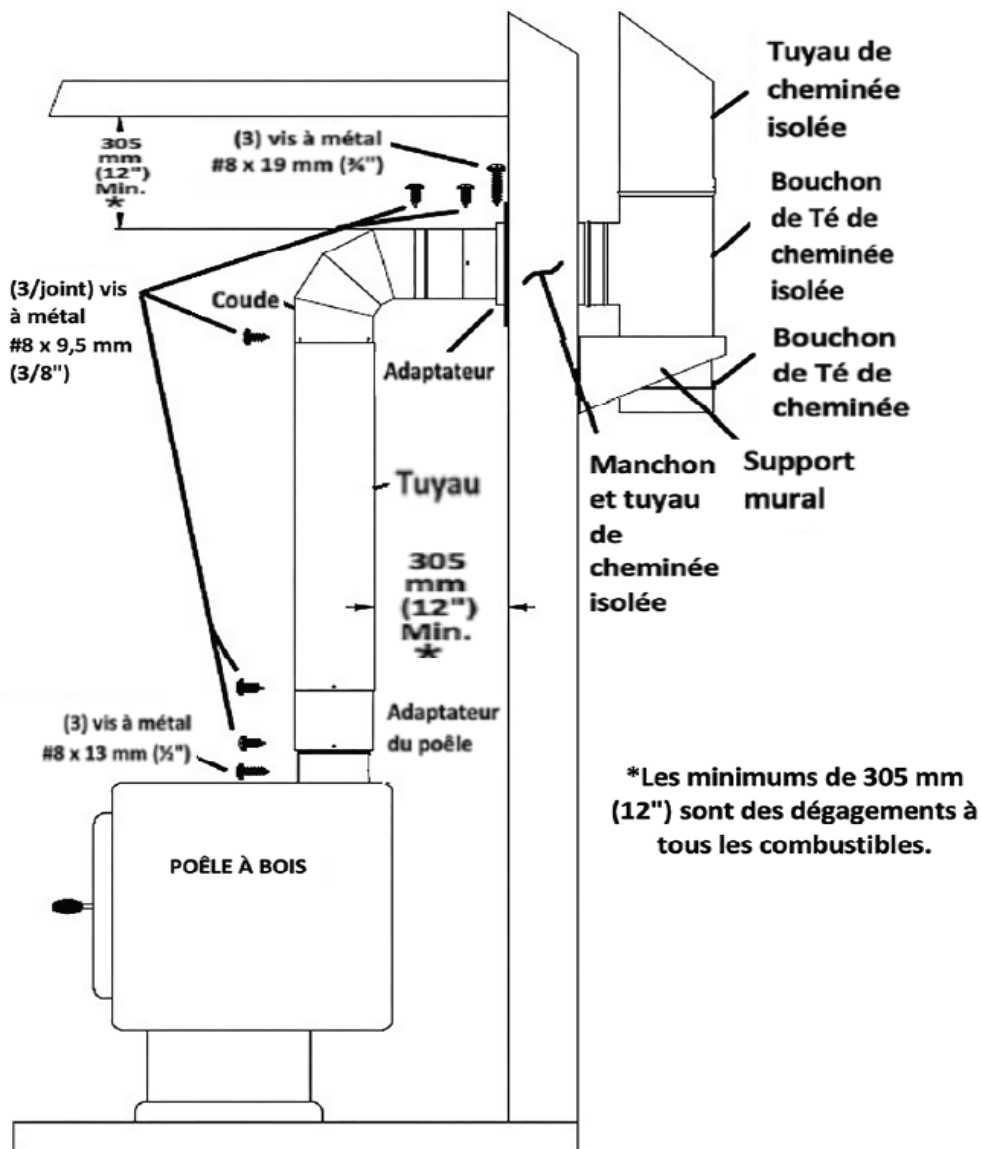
Installation d'un connecteur de cheminée à double paroi sur une cheminée isolée à paroi latérale
